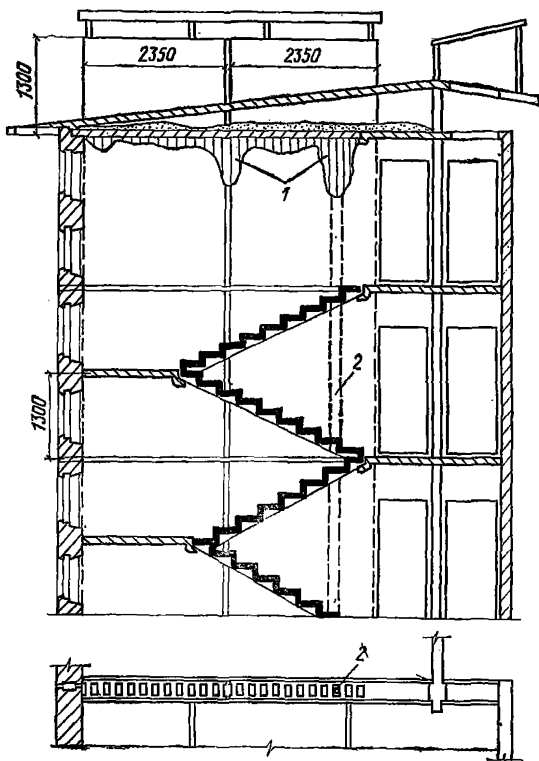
Места расположения протечек на вентиляционных панелях со стороны лестничных клеток
